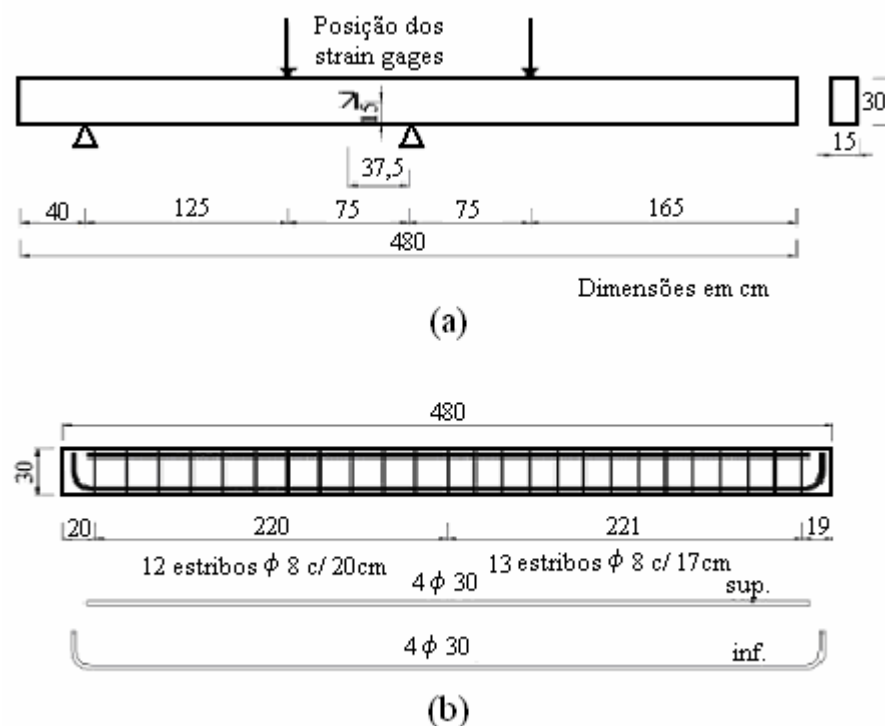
Dimensionamento das vigas ensaiadas (PELLEGRINO E MODENA, 2006).
